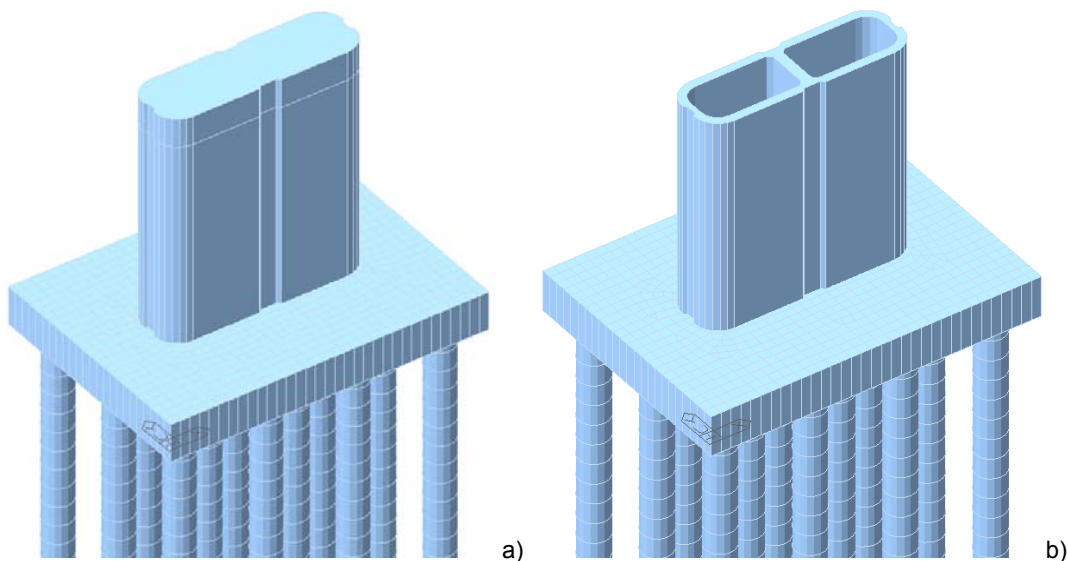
Modellazione tridimensionale agli Elementi Finiti – a) Vista 3D b) Spaccato
